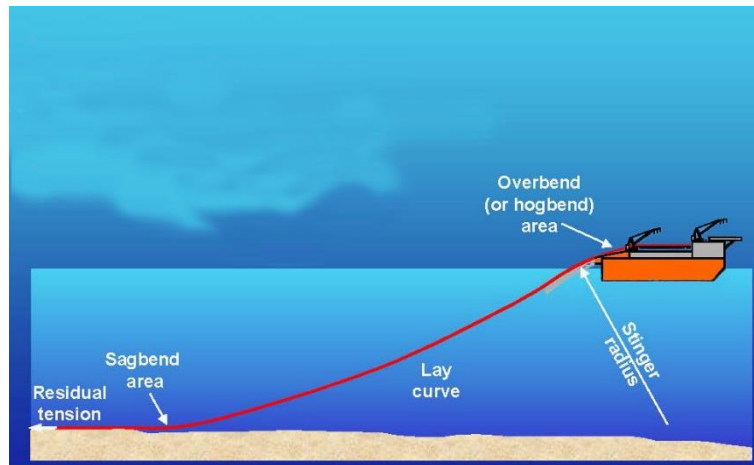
Disposizione generale a "S-lay" - Disposizione tipica
